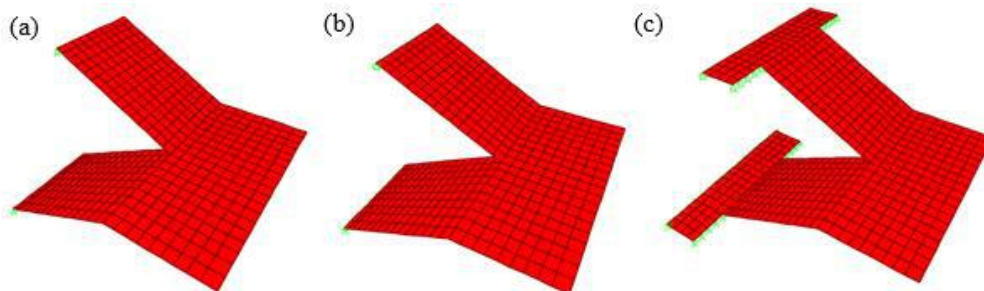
Modelo com elementos de barra: (a) apoiado, (b) engastado e (c) apoiado com continuidade.
